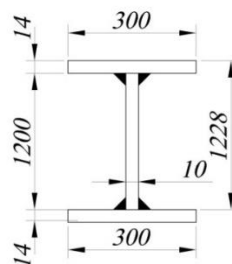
Сечение сварной подкрановой балки
